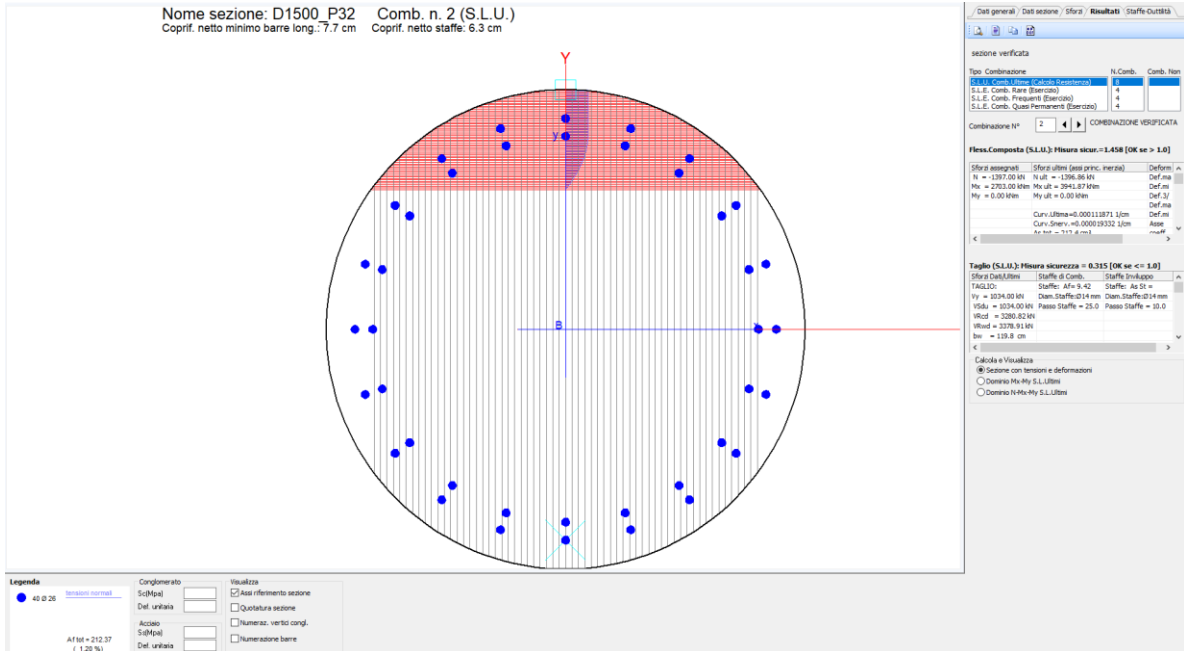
Verifica strutturale palo D1500mm – Pila 31, 32
